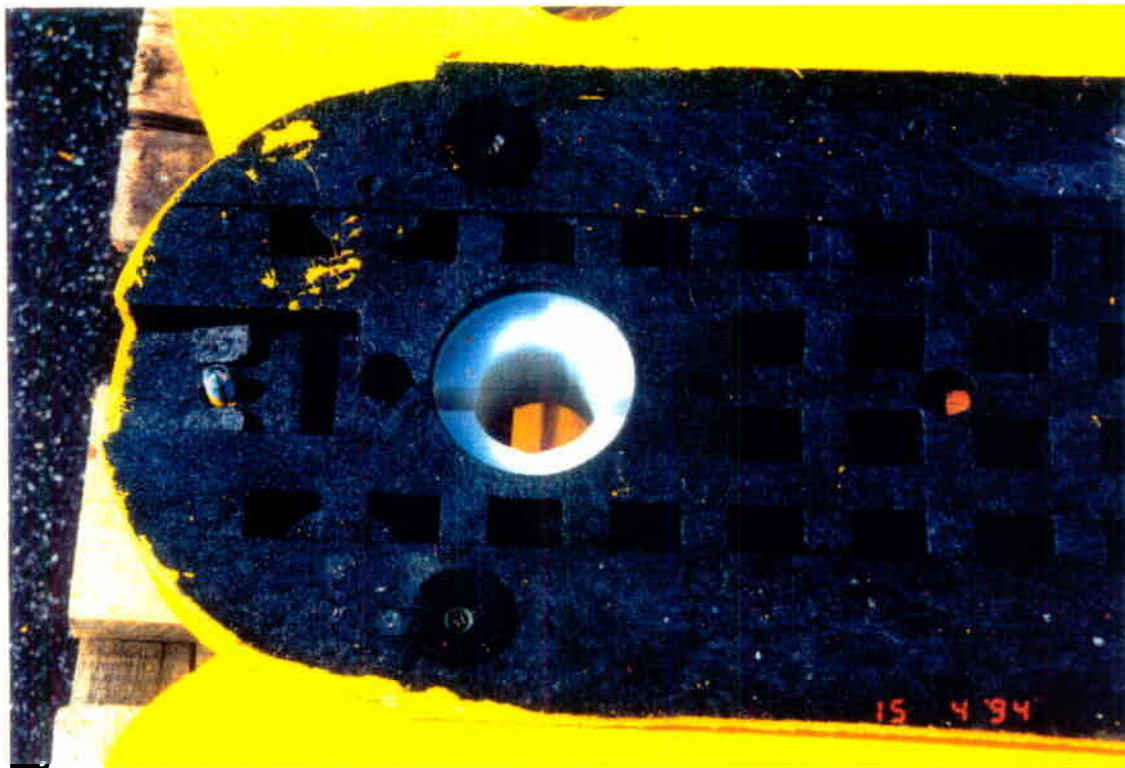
Leitschwelle Unterseite mit Rutschhemmern
